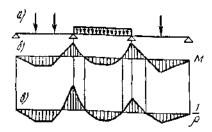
Эпюры изгибающих моментов и кривизны для железобетонного элемента постоянного сечения а—схема расположения нагрузки; б эпюра изгибающих жоментов, в—эпюра кривизны
